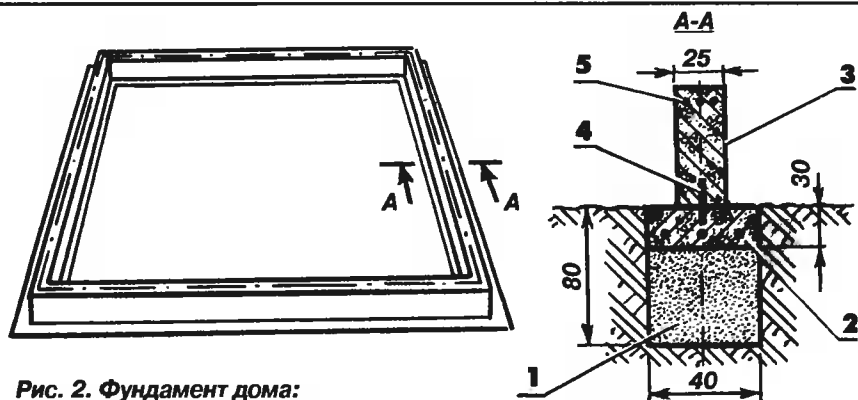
Фундамент дома: 1 – песчаная засыпка; 2 – основание фундамента; 3 – цоколь; 4 – штыри; 5 – прутья арматуры
